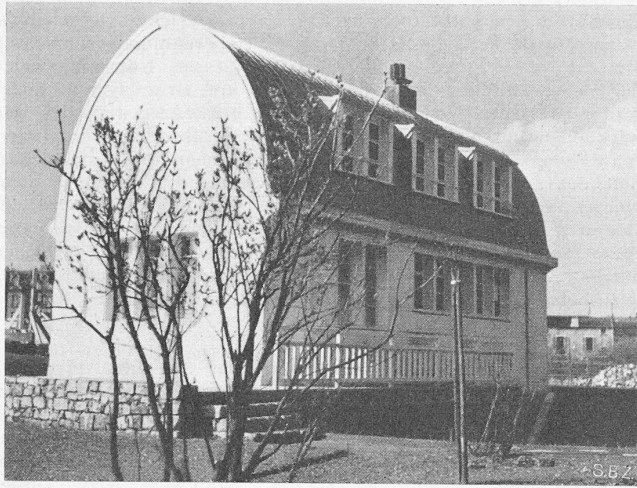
Maison «Schueller», Beton- und Stahlelemente
